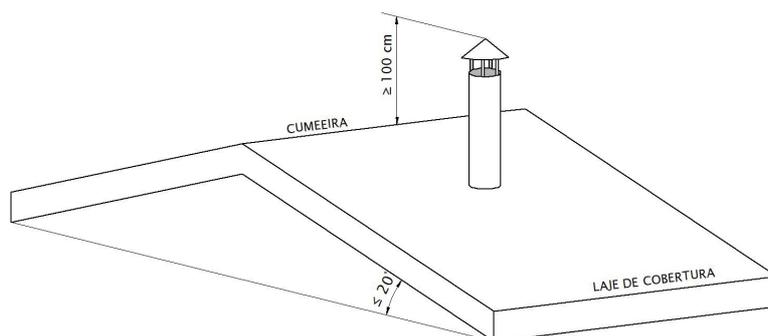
Instalação dos terminais verticais em coberturas consideradas planas.
